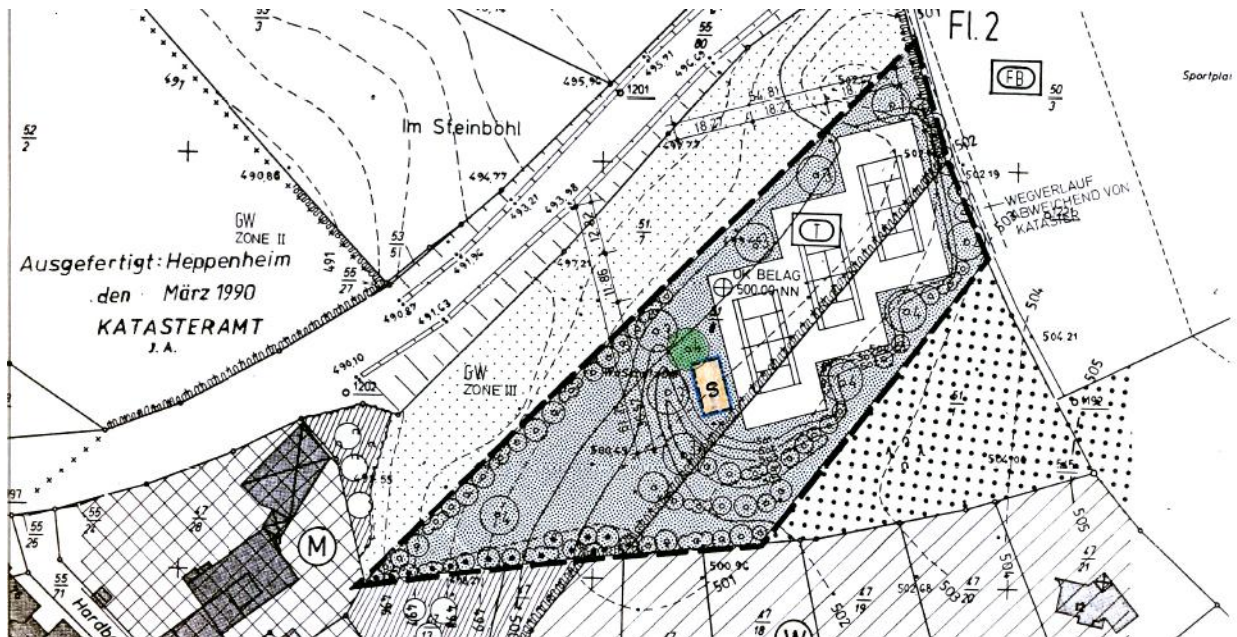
Bestehender Bebauungsplan im Teilbereich Tennisanlage
